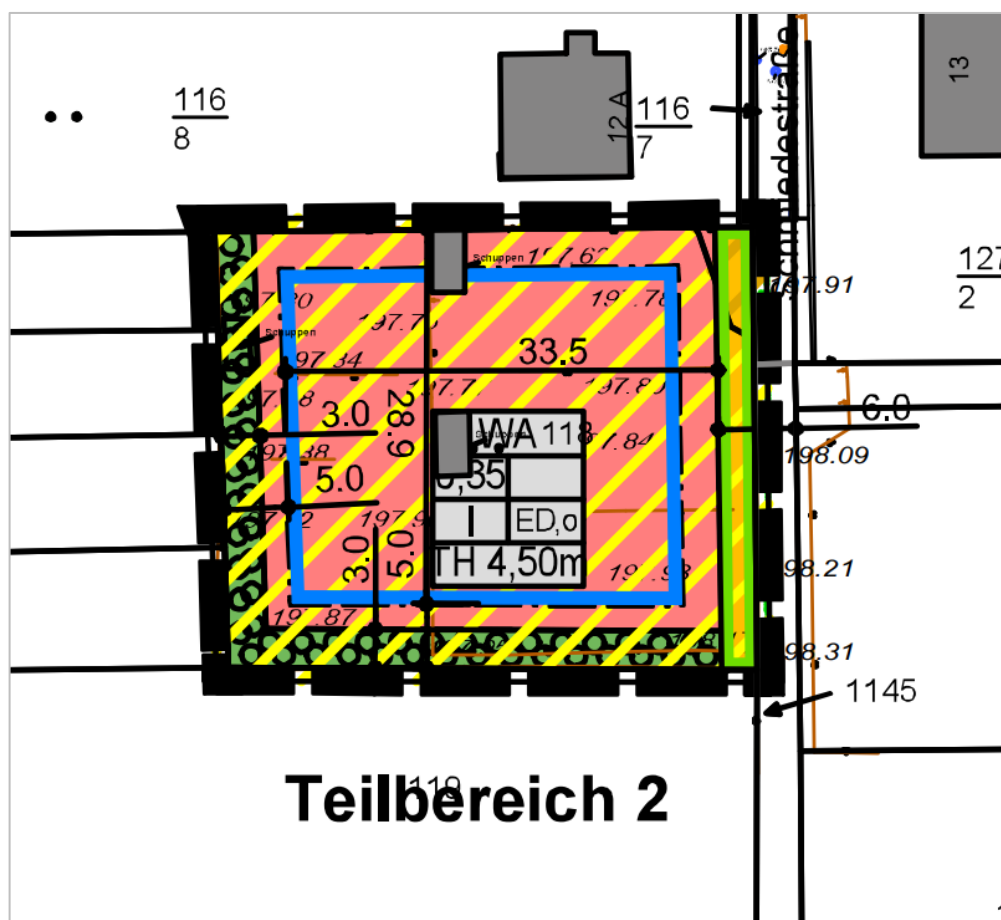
Teilauszug aus der Satzung zur 2. Änderung des Bebauungsplanes Nr. 69 „Börstedter Straße“ Ortsteil Silstedt nach § 13a Baugesetzbuch
